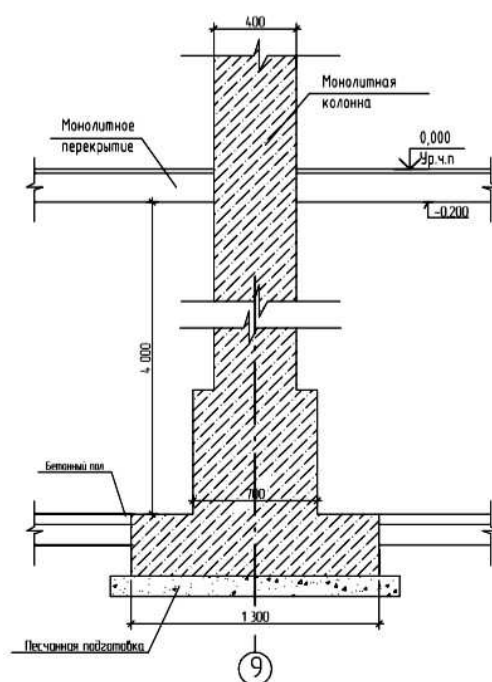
Сечение столбчатого фундамента Ф-1
